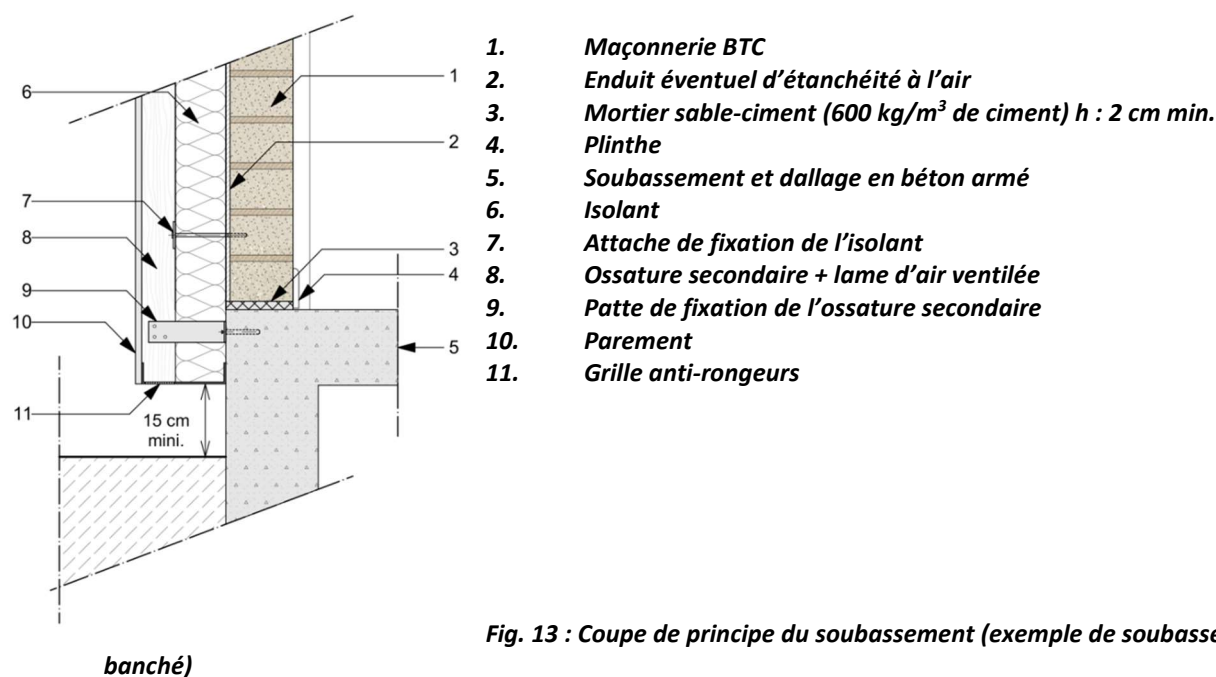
Coupe de principe du soubassement (exemple de soubassement en béton
